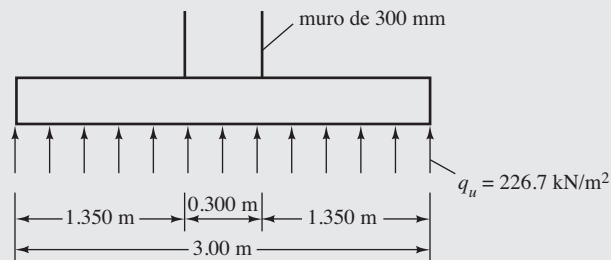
Zapata de muro para el Ejemplo 12.11.
